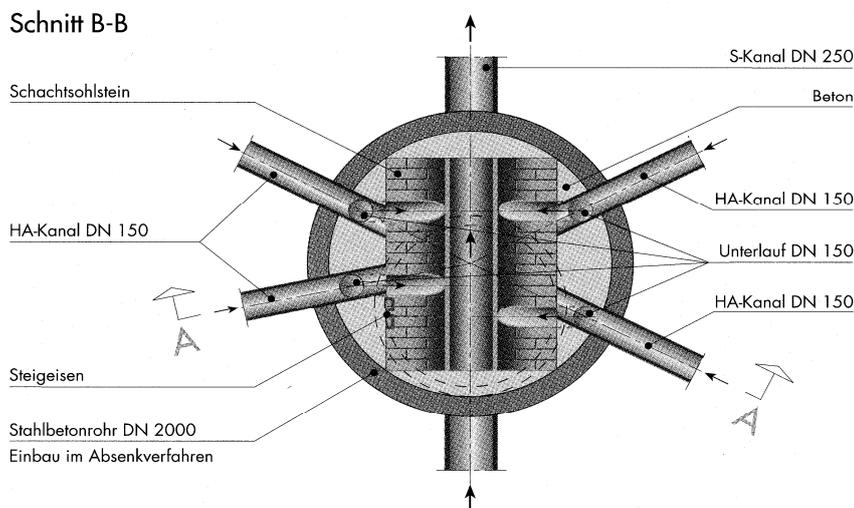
Sternförmiger Anschluss diverser Hausanschlussleitungen an einen Schacht [1]
